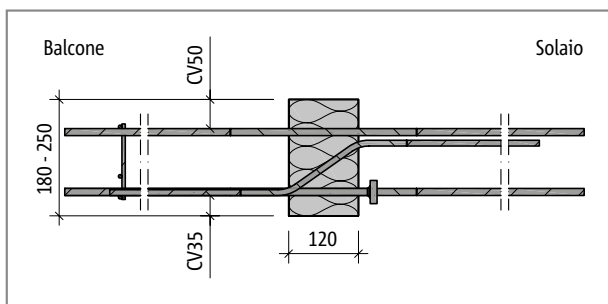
Schöck Isokorb® tipo EXT-L-CV50: sezione dell'elemento
